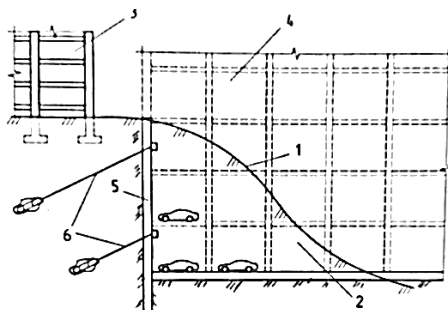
Схема освоения крутого склона оврага с использованием железобетонной подпорной стенки, возведенной способом «стена в грунте»: 1 – склон оврага; 2 – подземная часть здания; 3 – надземное многоэтажное здание; 4 – надземная часть здания; 5 – подпорная стена, возведенная способом «стена в грунте»; 6 – грунтовые анкера
